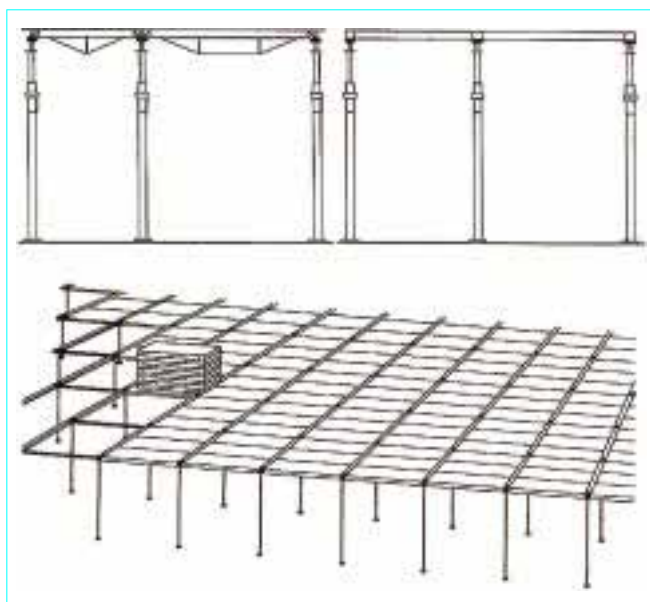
Poutrelles supports de coffrages modulaires préfabriqués s'appuyant sur des étais télescopiques
